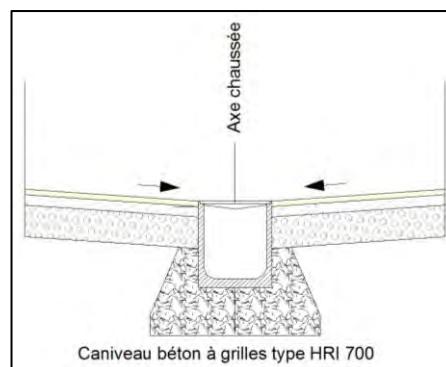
EXEMPLE DE PROFIL EN TRAVERS TYPE POUR POSE D'UN CANIVEAU GRILLE
